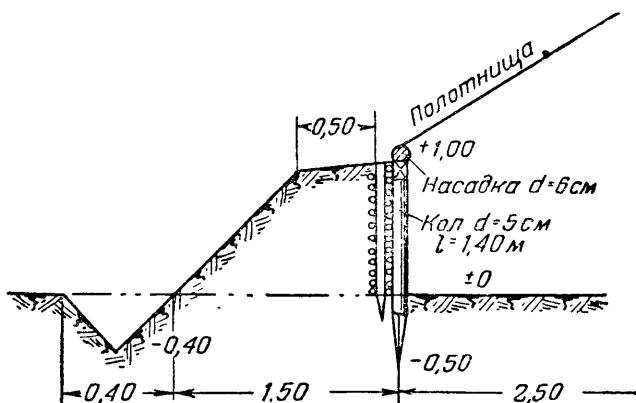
Устройство стенки из плетня с земляной присыпкой
